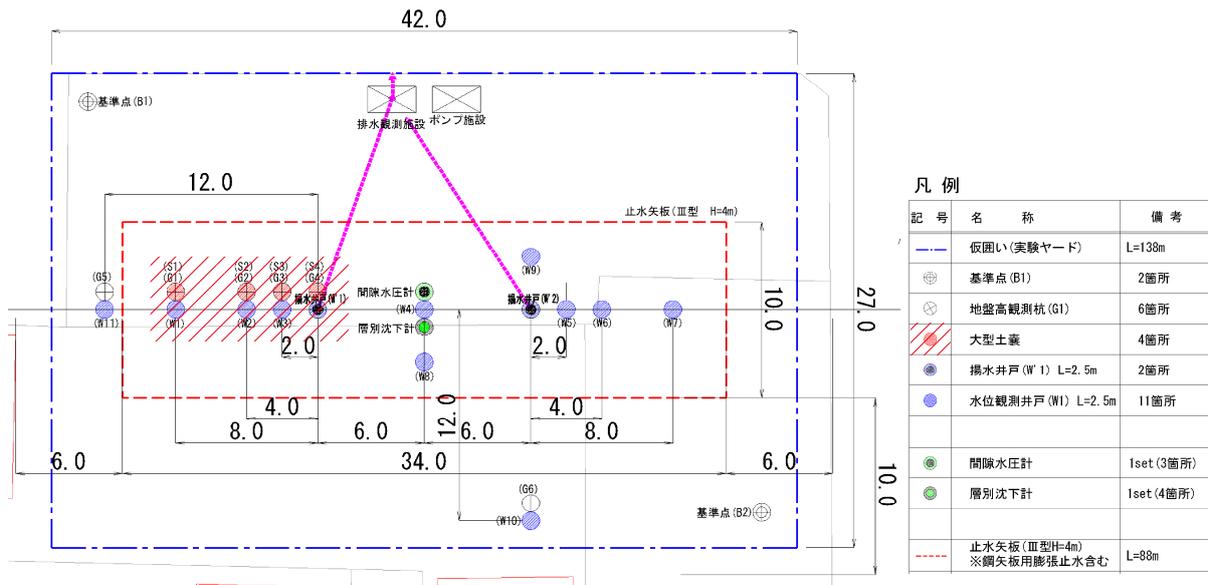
井戸方式による実証実験の平面図 (我孫子市)
